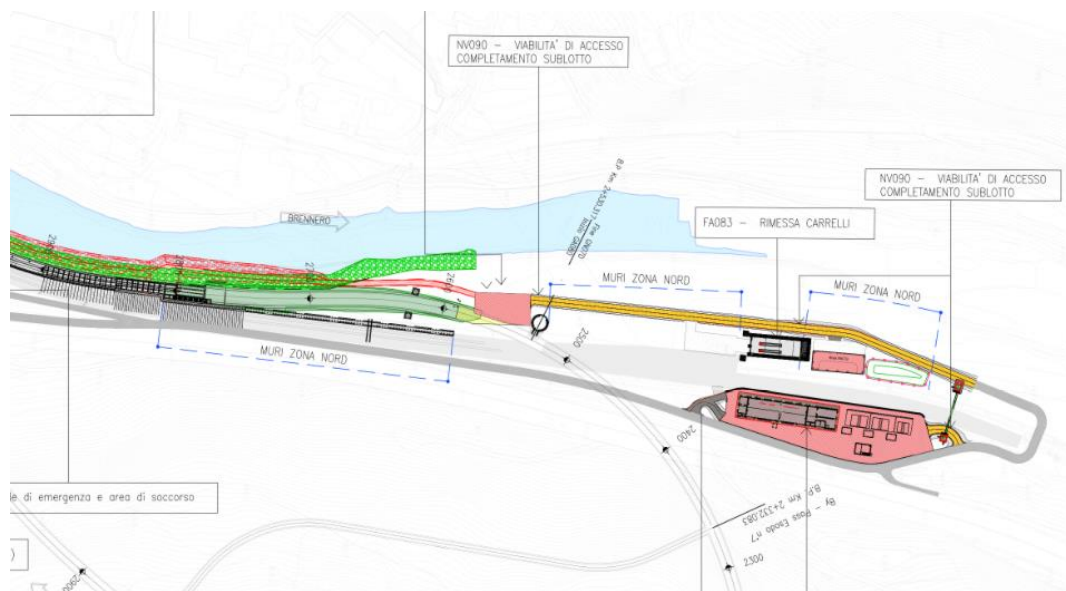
Planimetria di PE in zona Ponte Gardena - configurazione dei tralicci Terna mantenuta invariata rispetto allo stato attuale
